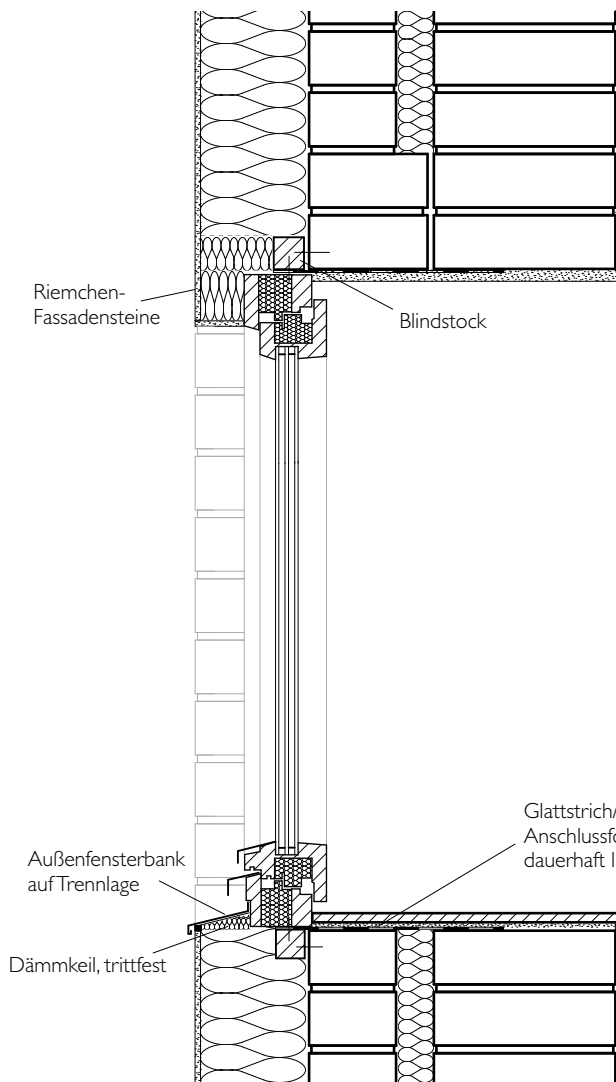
Fensterdetail, Befestigung am Mauerwerk mit Blindstock, M 1: 10
